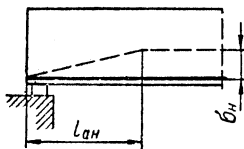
Схема распределения предварительно напряженного по длине арматурной проволоки (без анкеров) после обжатия бетона.
